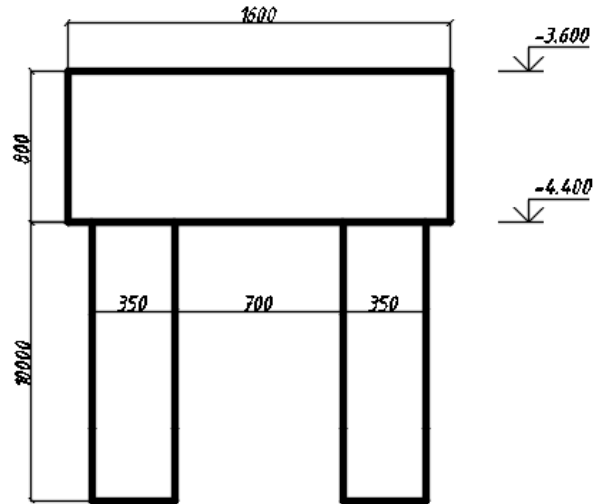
Конструктивна схема палевого фундаменту. Варіант 1
